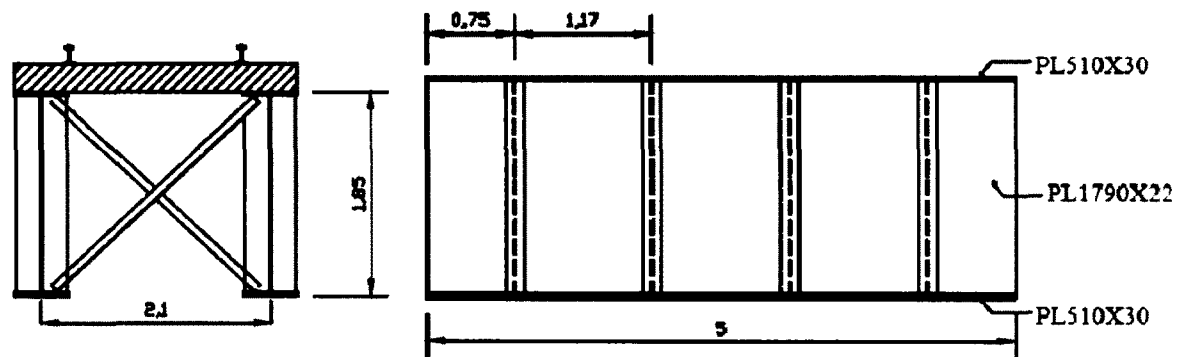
Pont bi-poutres - Section transversale et élévation - Section F-2
